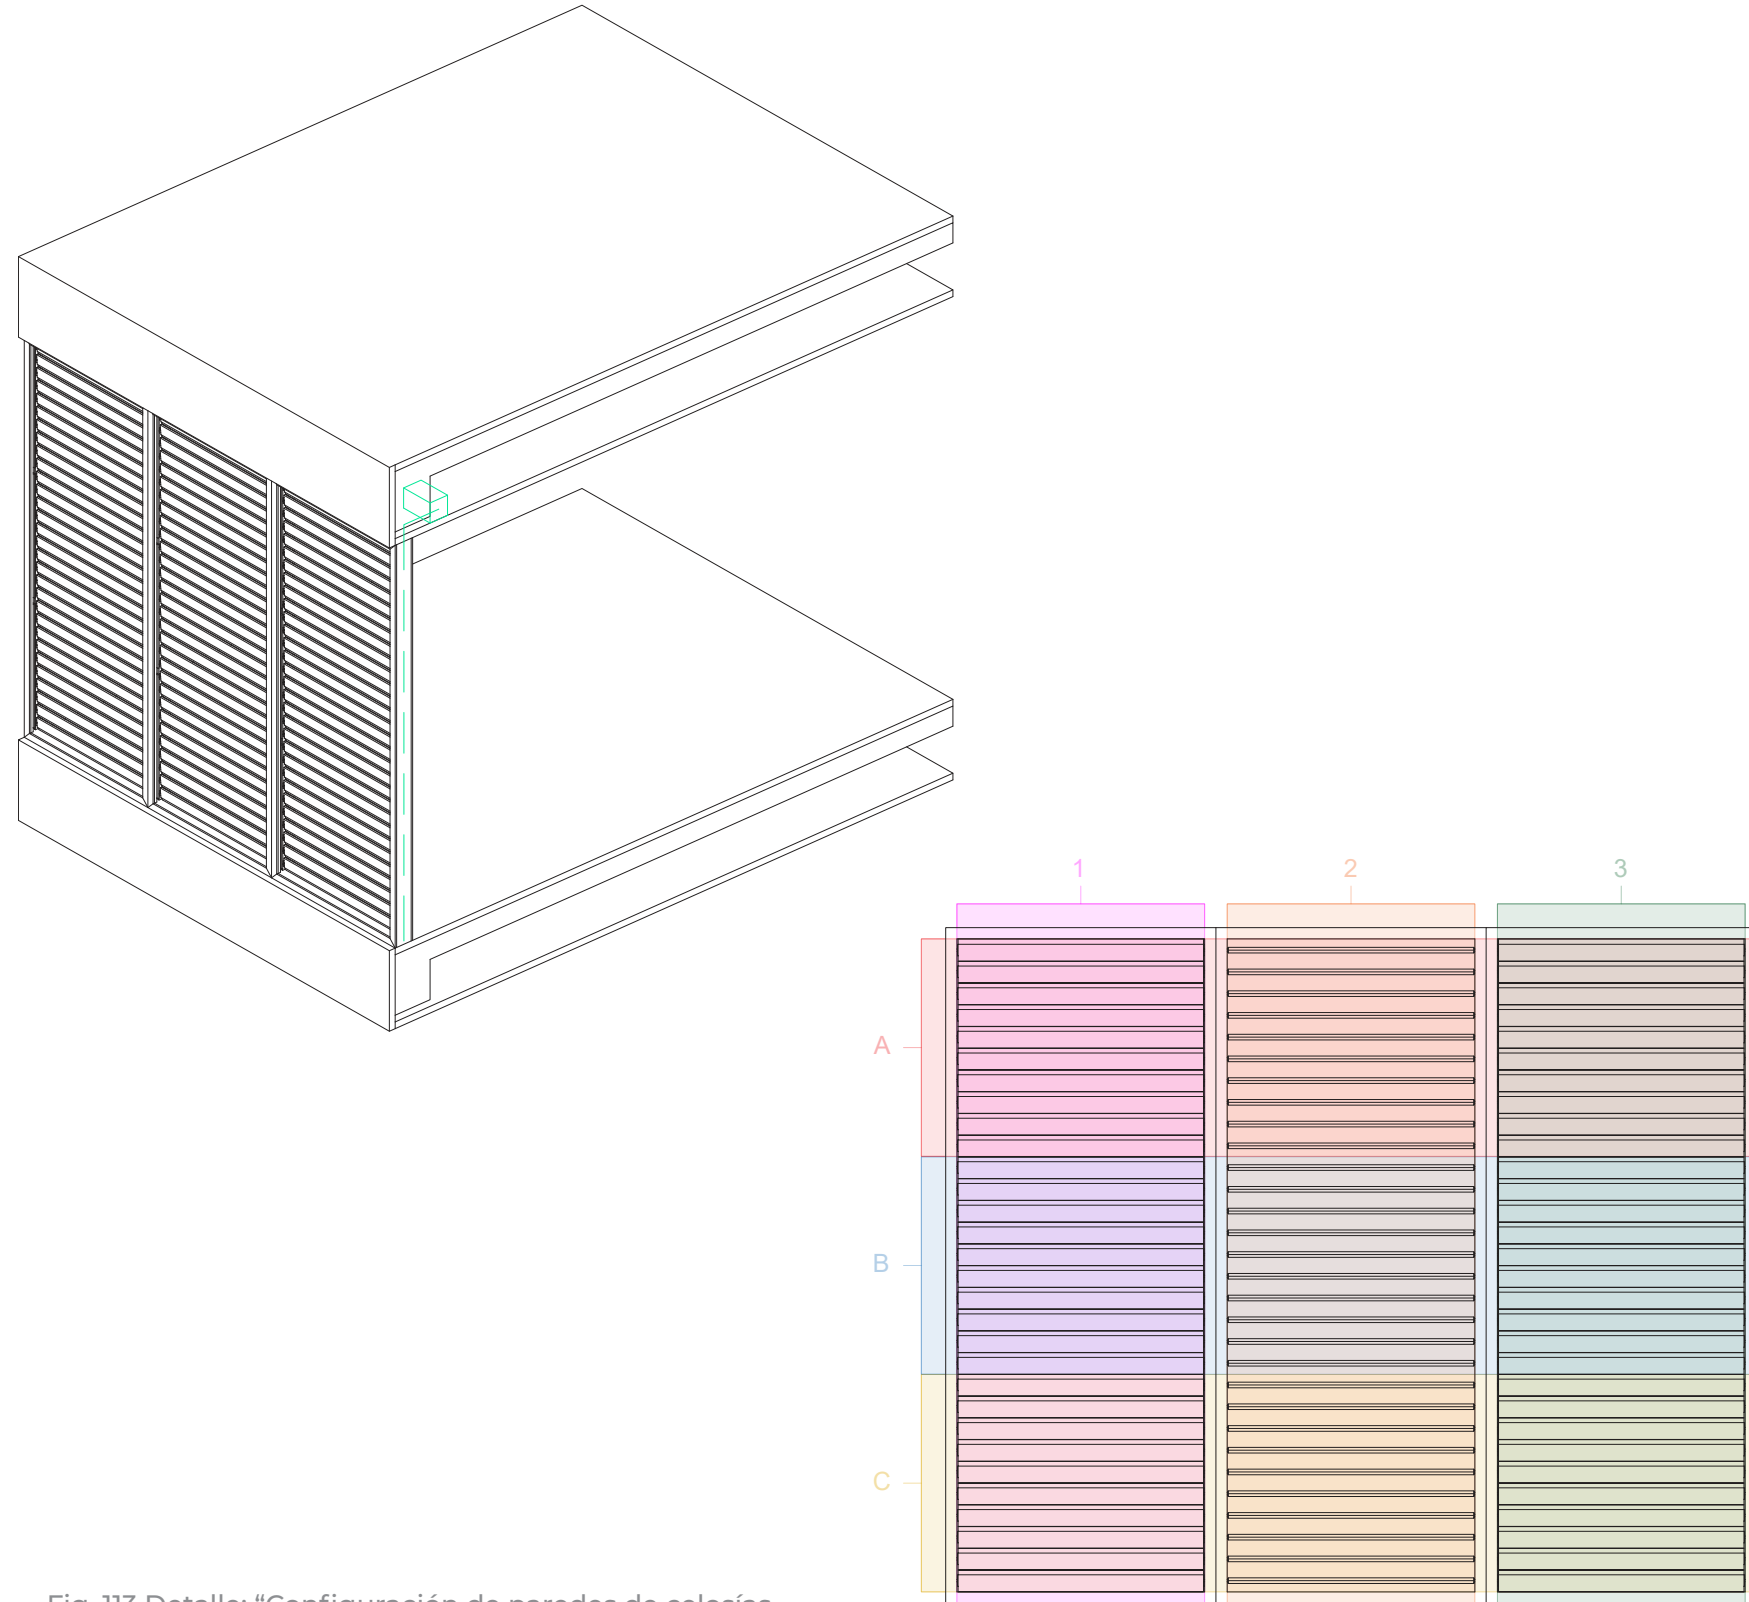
Detalle: "Configuración de paredes de celosías exteriores". Elaboración propia.
